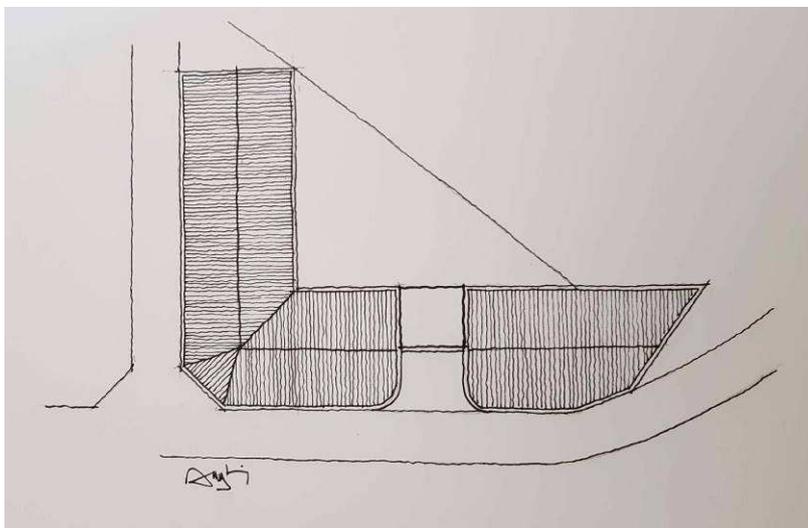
Foto que revela o partido de planta do Edifício Luz, semelhante ao projeto original
